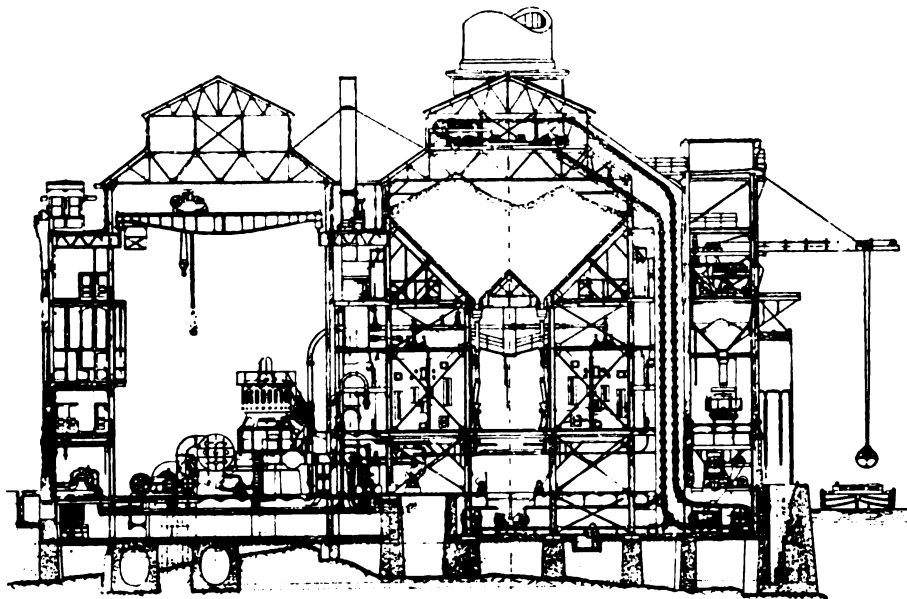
Centrale elettrica della « New York Central Railway ». — Sezione trasversale (1).
